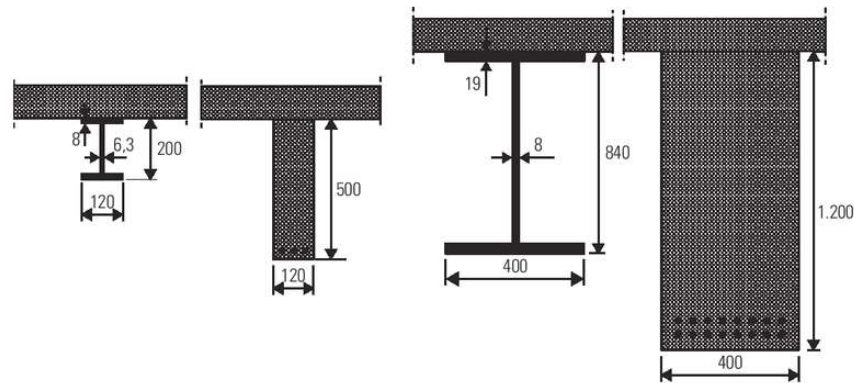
Comparação entre vigas de aço e de concreto armado (dimensões em mm).
